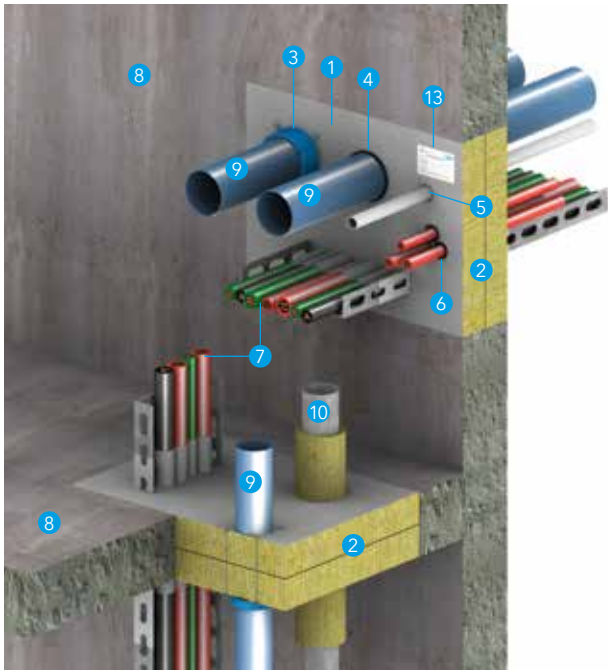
Detail D - Massieve wand, lichte scheidingswand en massieve vloer
